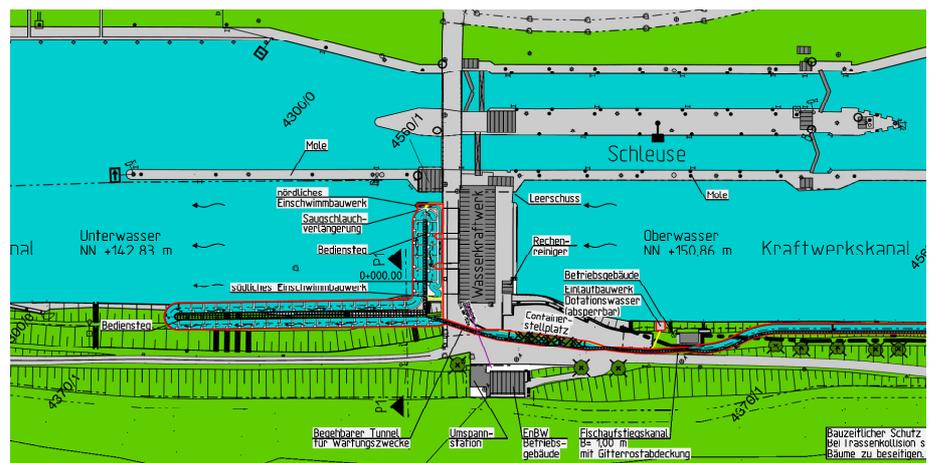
Planausschnitt Lageplan Variante 3 – Vorplanung (Stand Oktober 2011)
